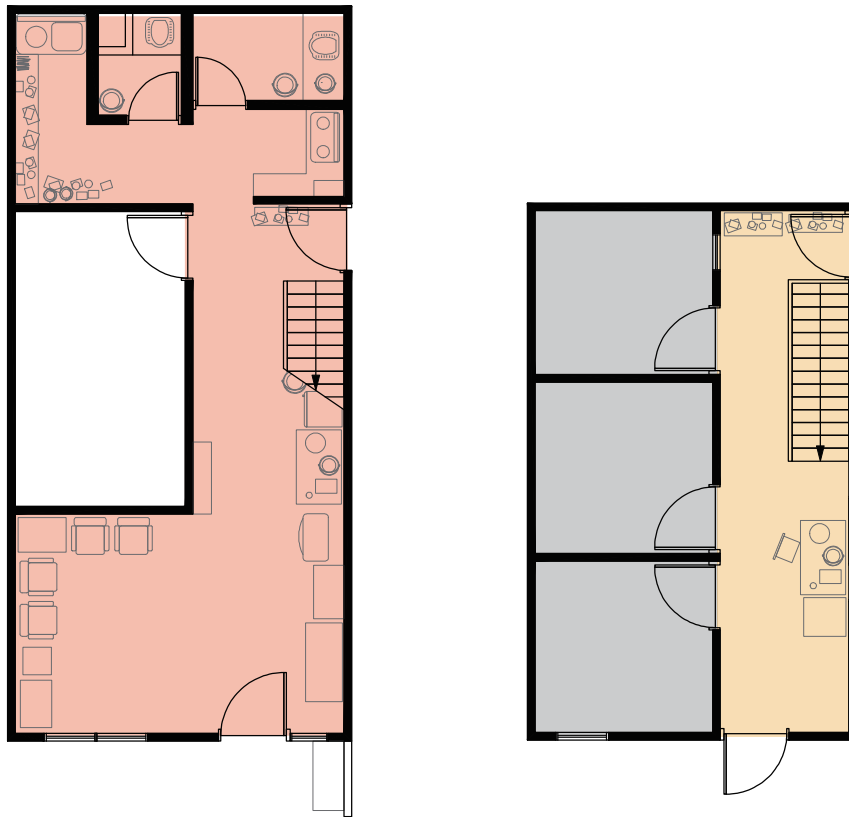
コス㊴;一階平面図 (左) と 2 階平面図 (右) (1:50)
